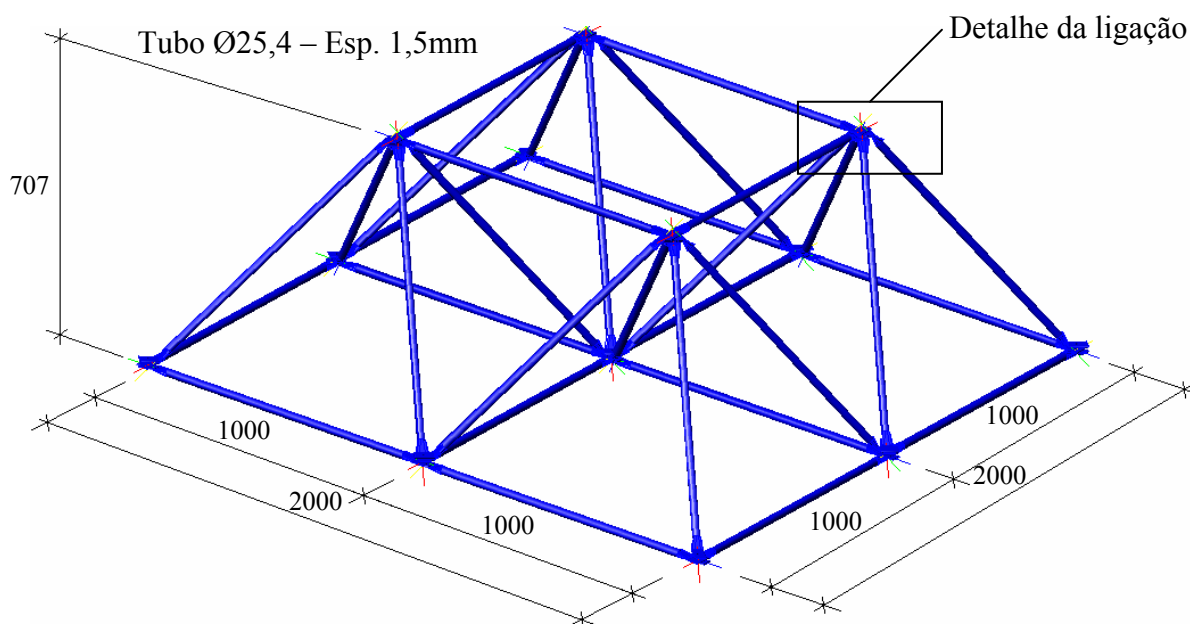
Modelo da estrutura treliçada tridimensional adotada, cotas em milímetro
